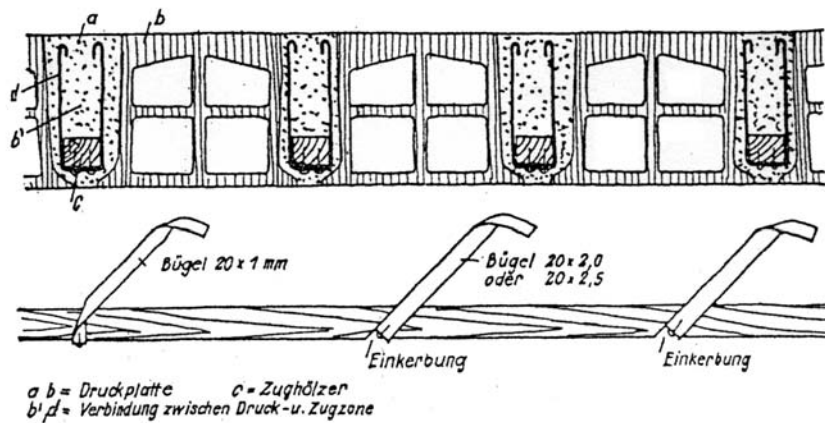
Holzbewehrte Hohlsteindecke Sperle"
